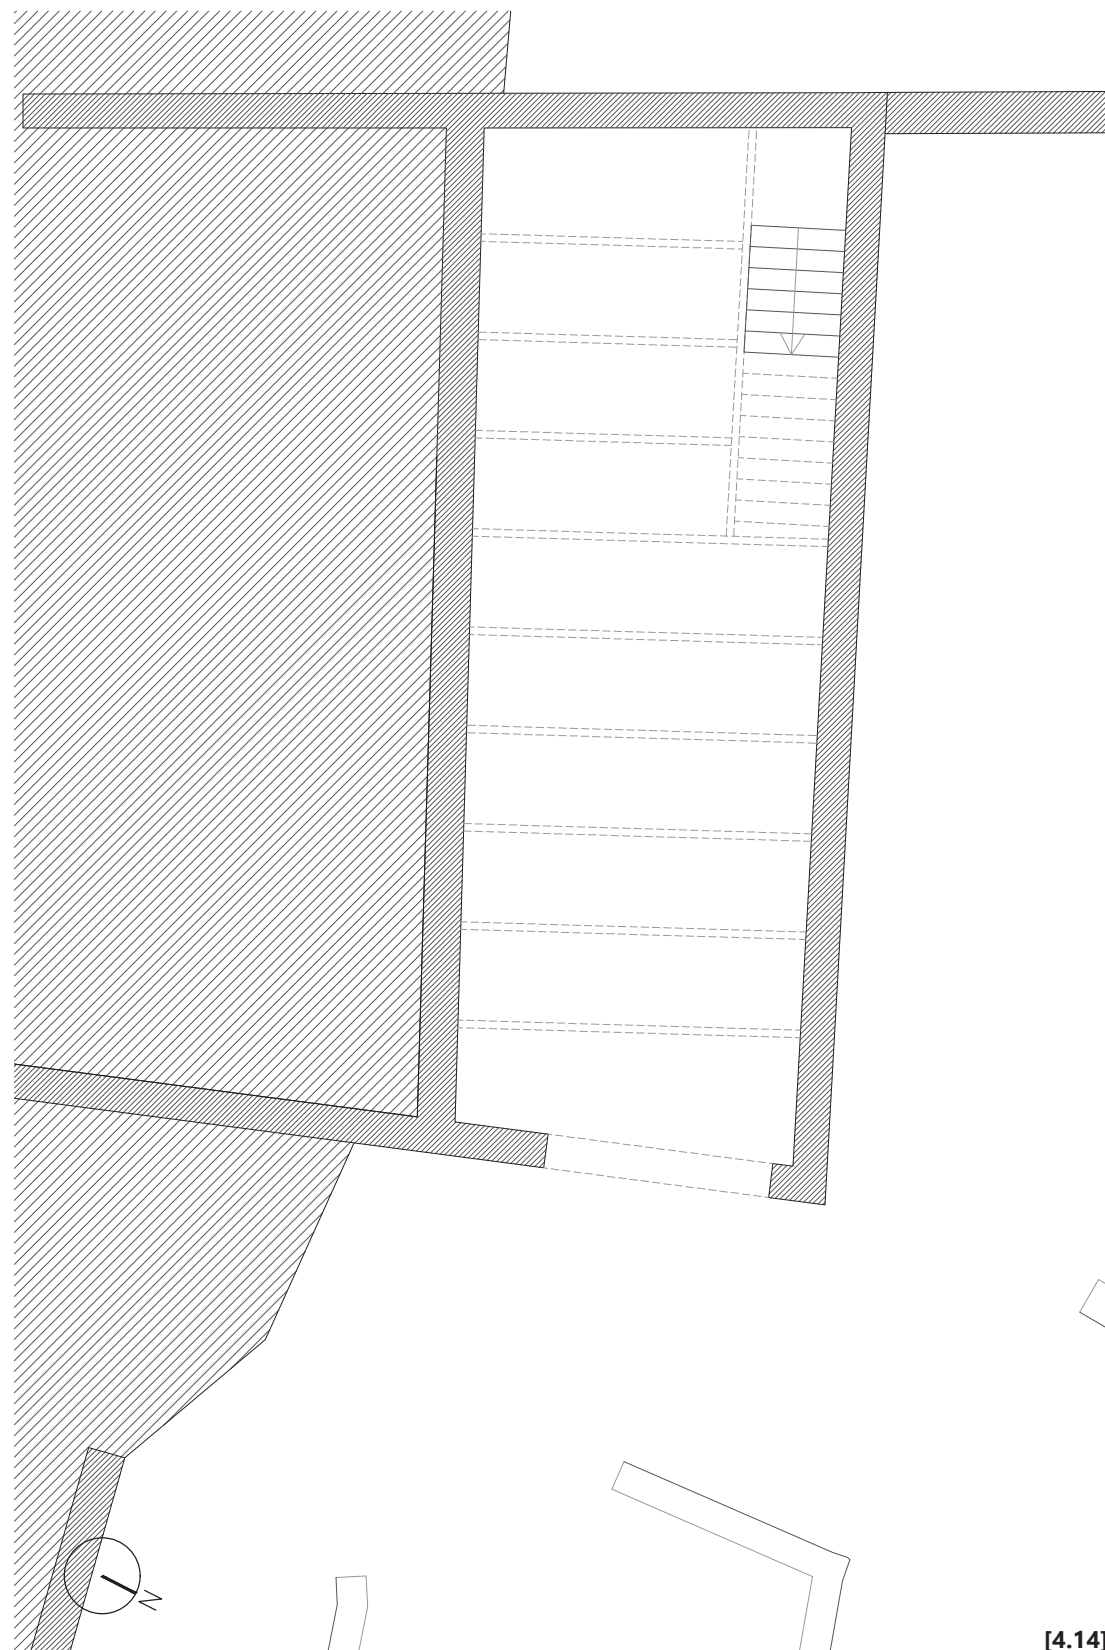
Reabilitação da casa - Planta do Piso -1. Esc.1/100.
